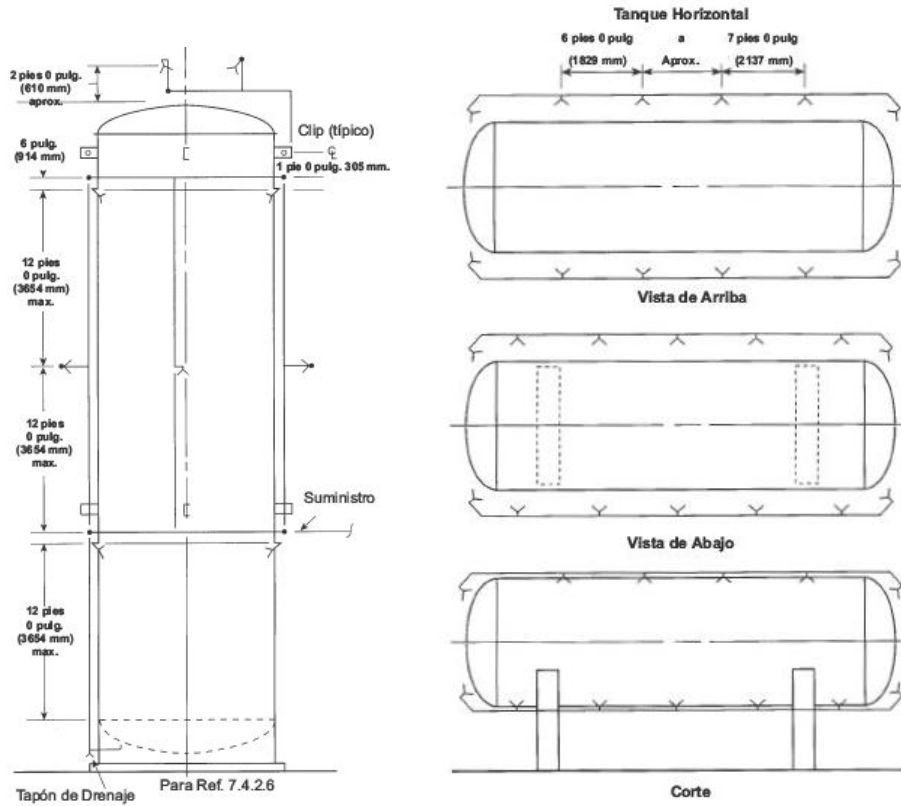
Distanciamiento entre boquillas para separadores verticales y horizontales
